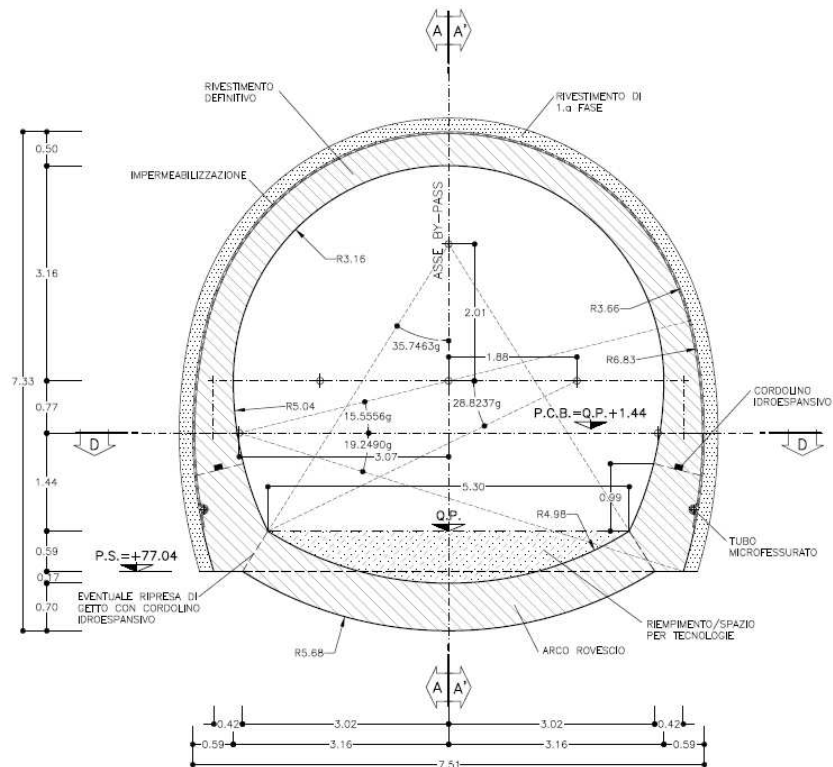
Carpenteria sezione corrente by-pass di collegamento
